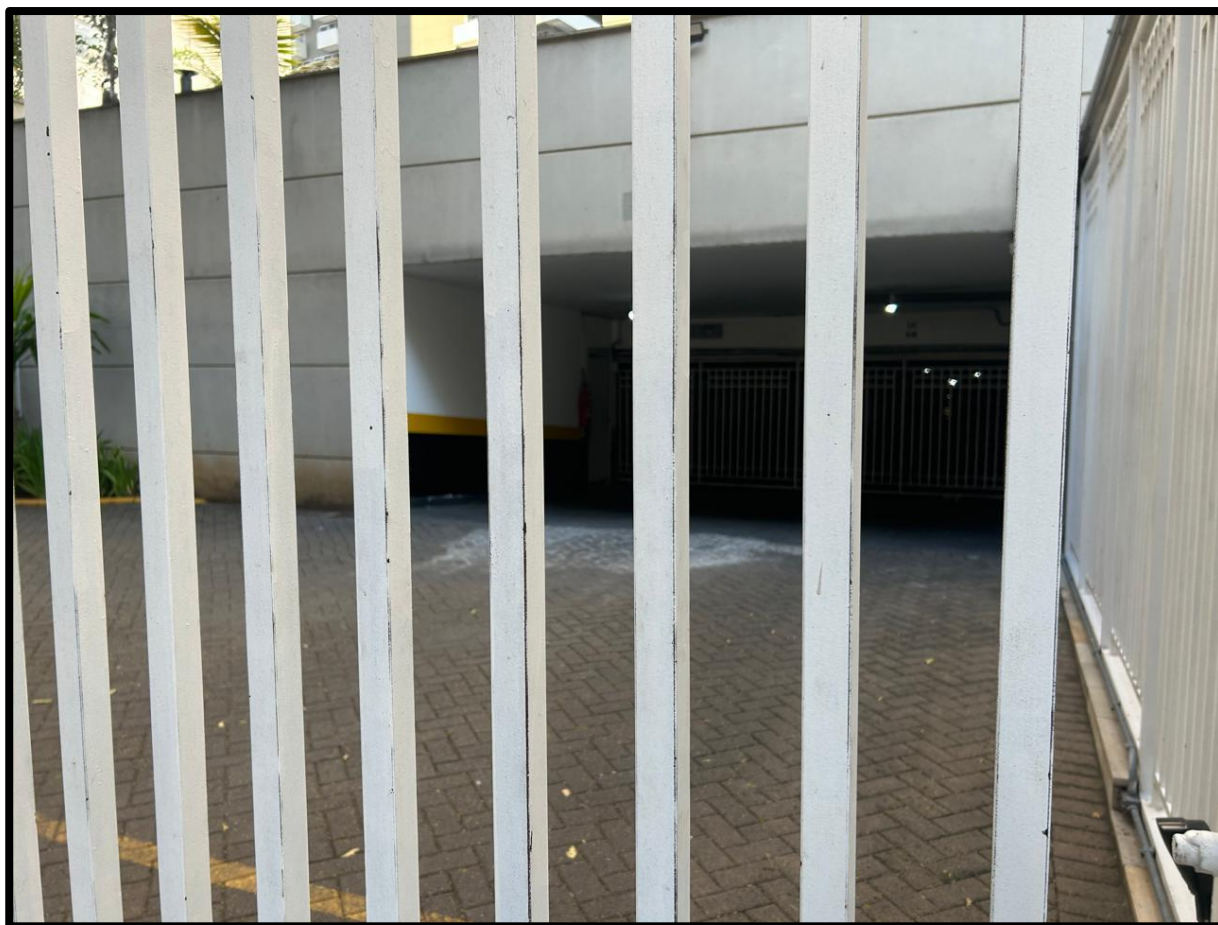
Vista do acesso de veículos para o subsolo de garagem.
